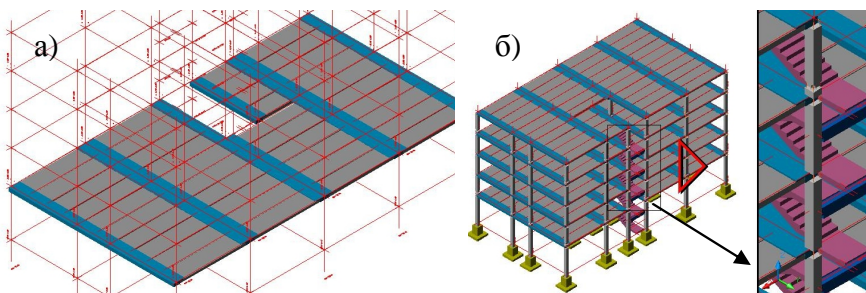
Формирование сборно-монолитного диска перекрытия:
